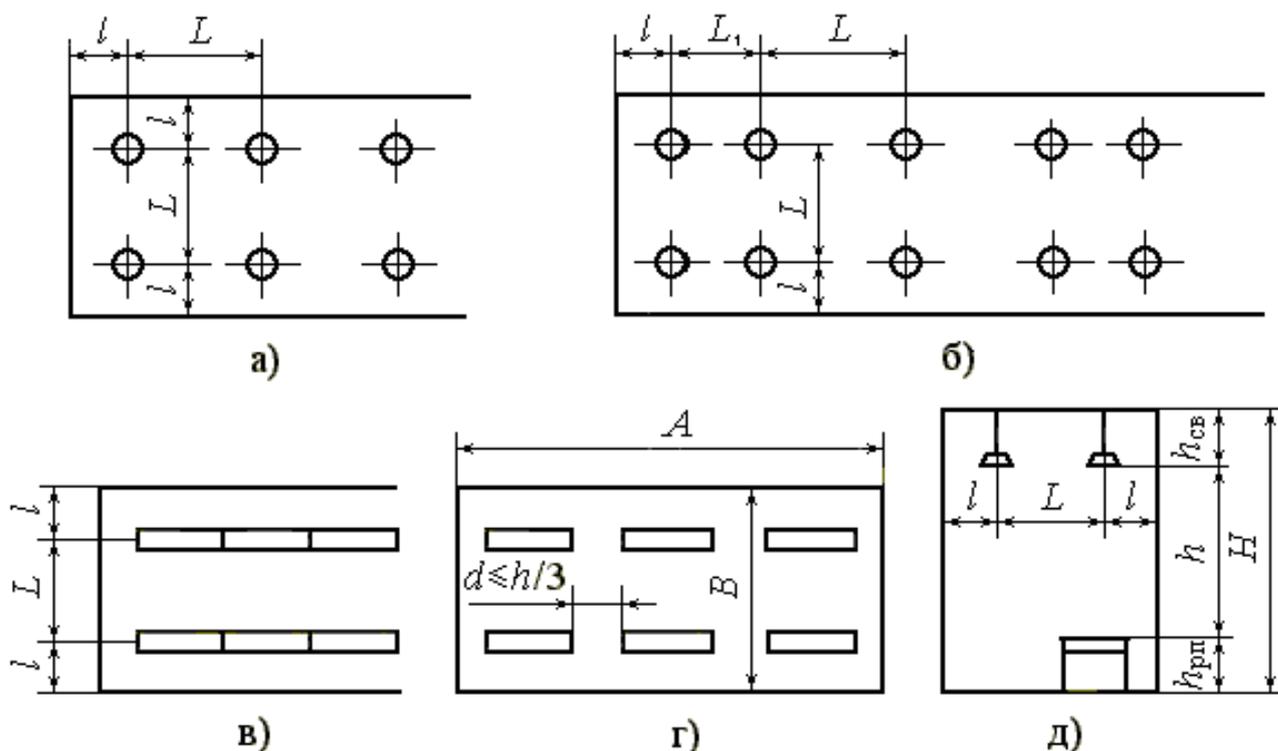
Размещение светильников общего освещения в помещении: а, б – в плане – с лампами накаливания; в, г – в плане – с люминесцентными лампами; д – в разрезе (по высоте помещения)
